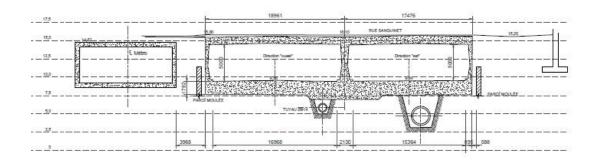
Ejemplo de sección transversal en las cercanías del metro de Montreal
